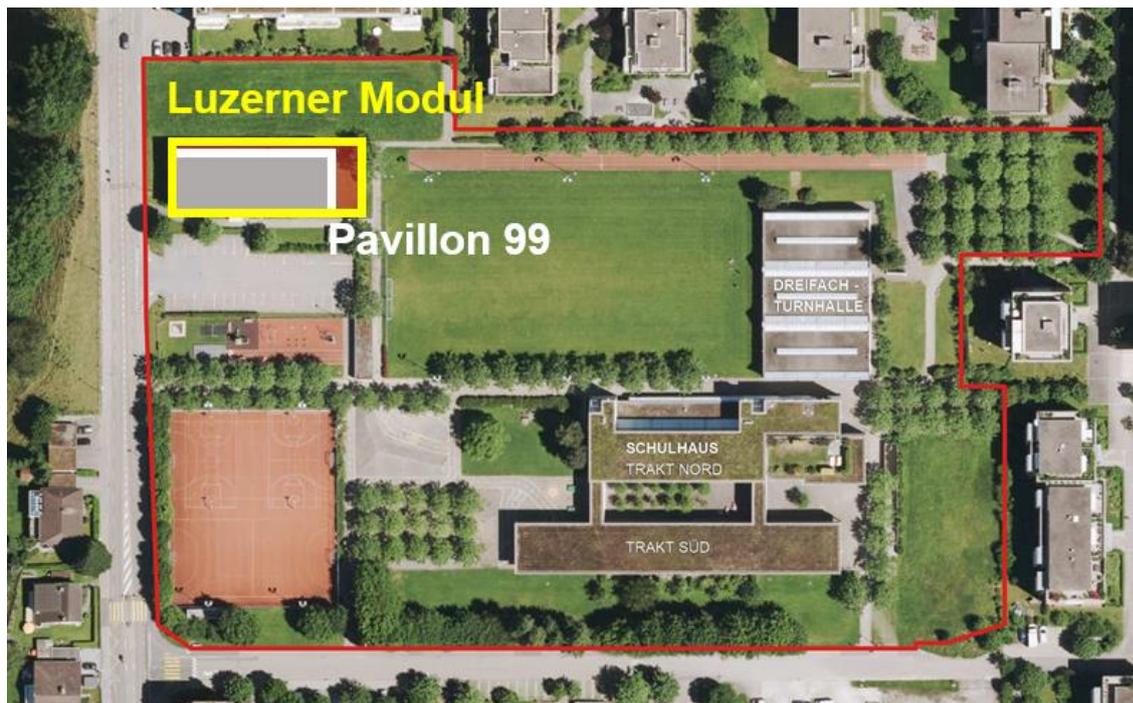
Situationsplan Schulanlage Ruopigen mit «Luzerner Modul» (Ersatz Pavillon 99)
